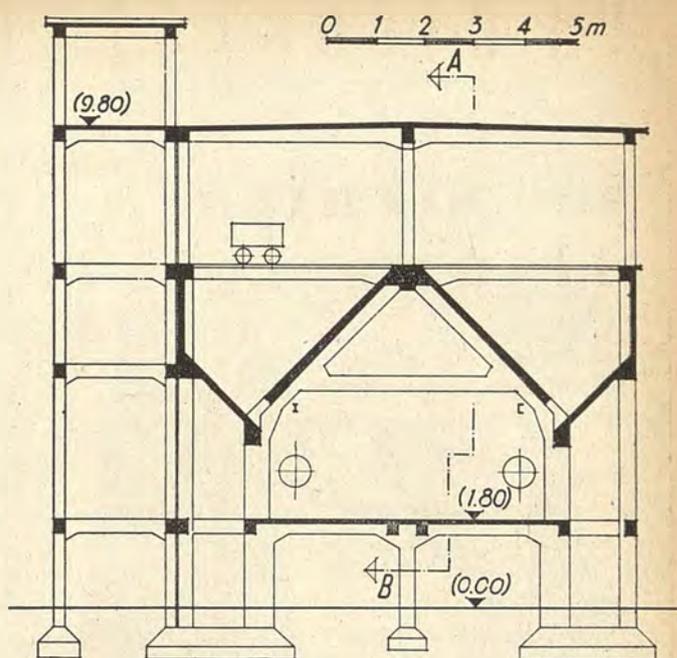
Stazione intermedia (Sezione trasversale sulle tramogge).
